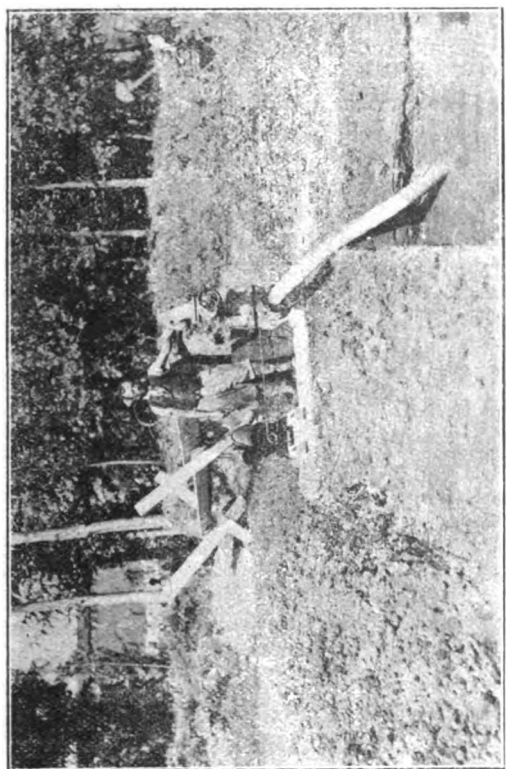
Costruzione di una fondazione in terreno acquitrinoso.
